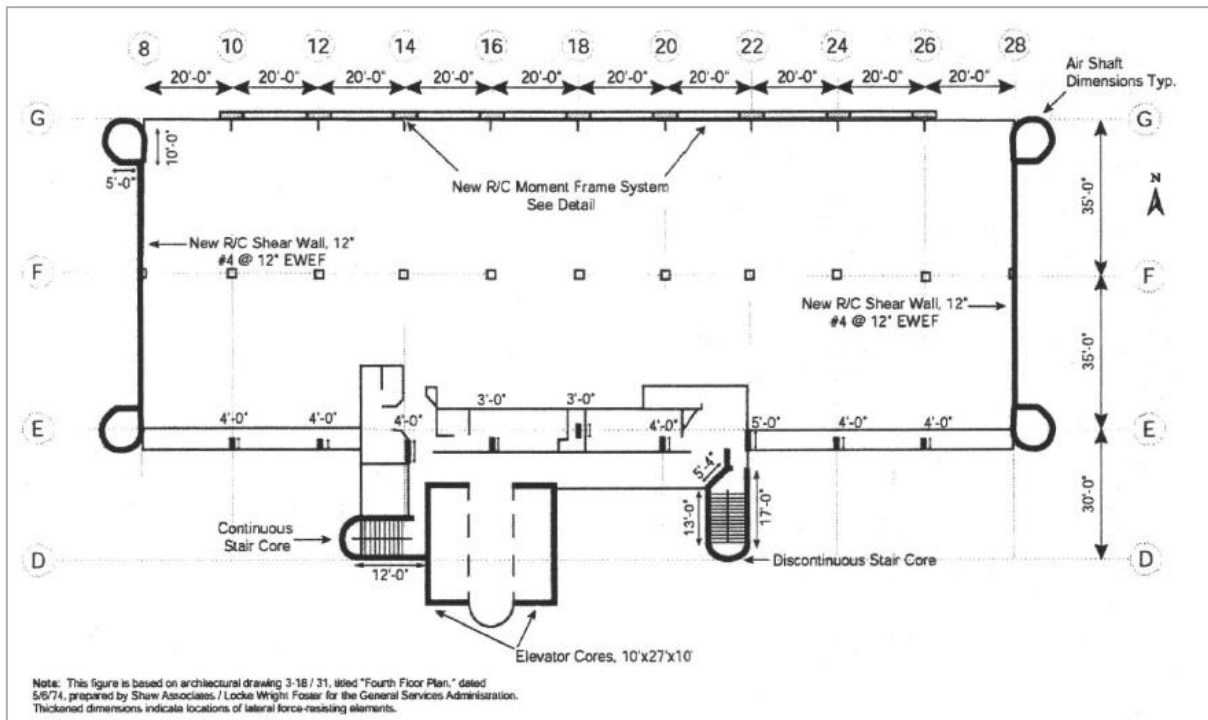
Planta del cuarto piso de la estructura, con detalles de algunas dimensiones. [26]
